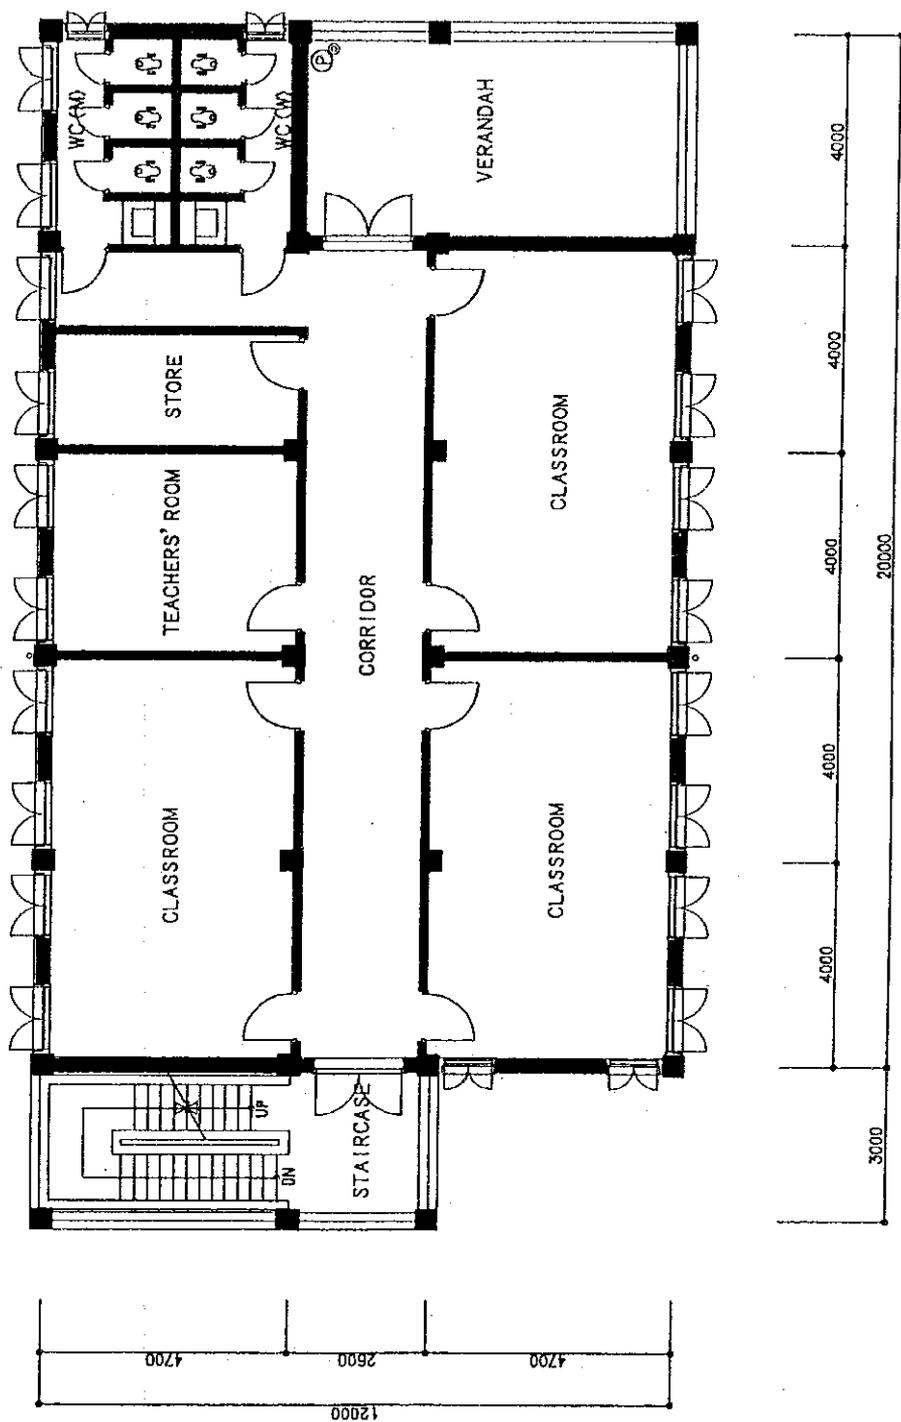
(2) 2 階平面図 (3 教室タイプ)
